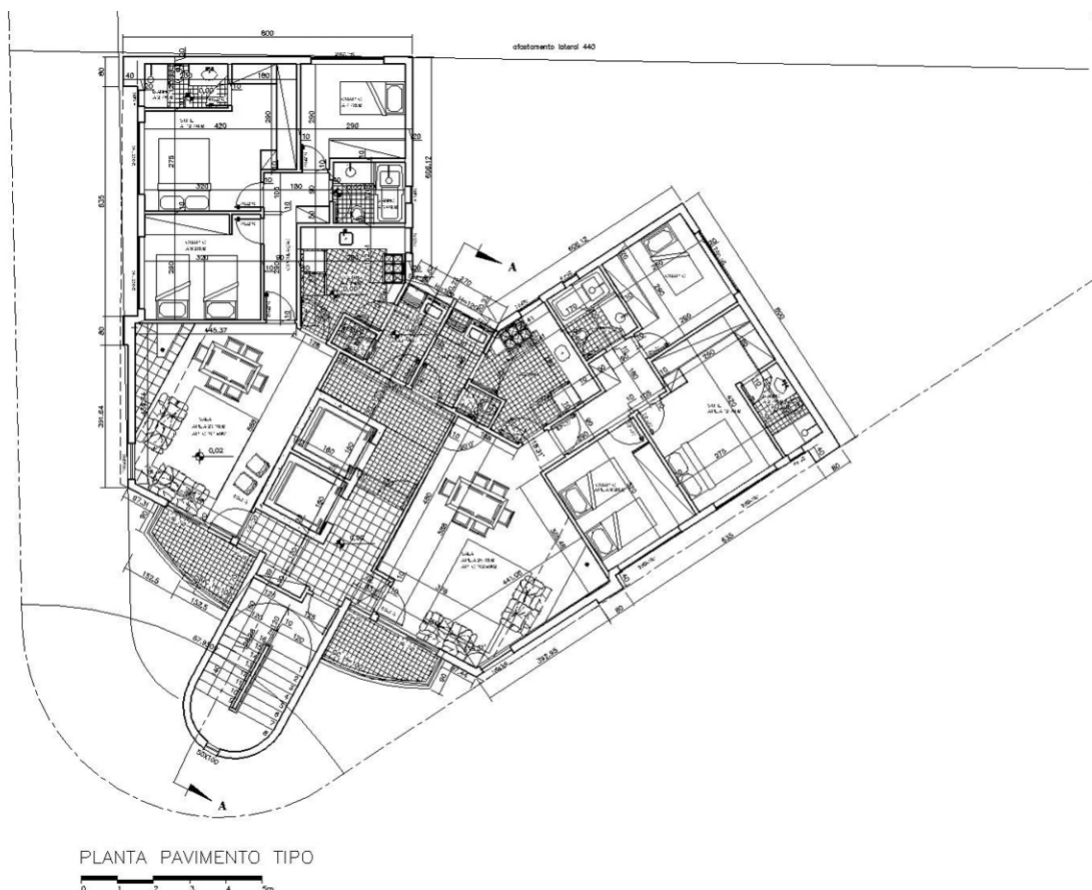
Pavimento tipo do edifício Bouganville. Fonte: Construtora Castro Pimenta
